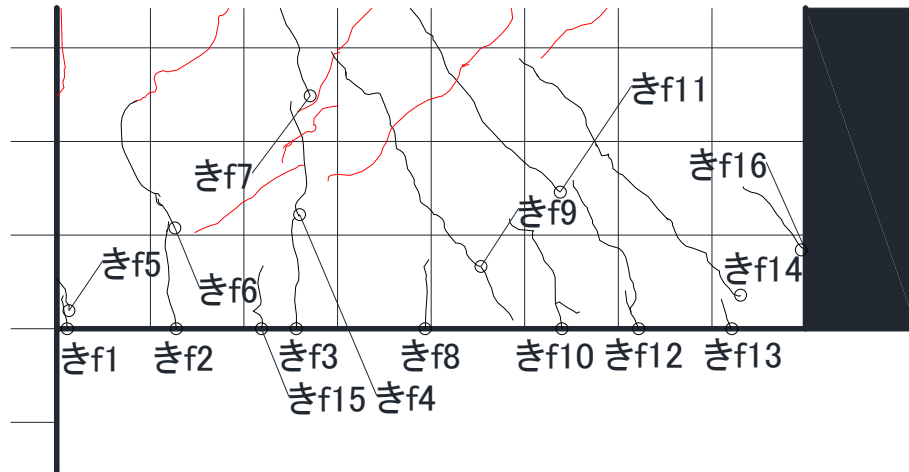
2. 3-64 基礎梁ひび割れ幅測定位置(試験体 DR-1 +7.0 サイクル 観測面)
